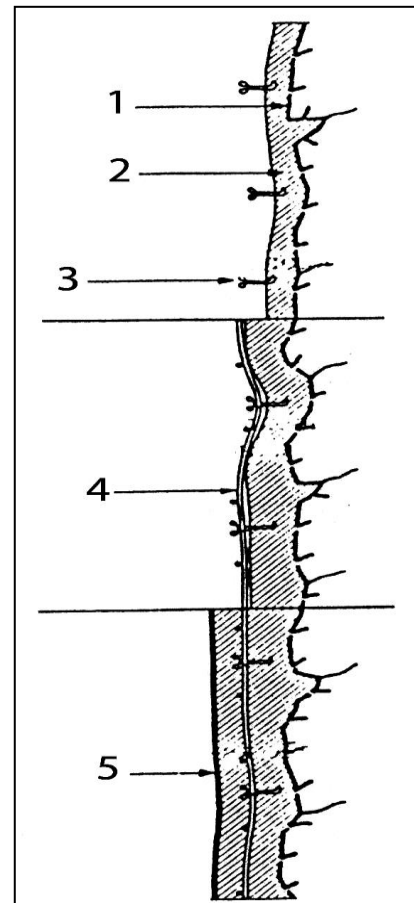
Кріплення арматурної сітки в'язальною проволокою
